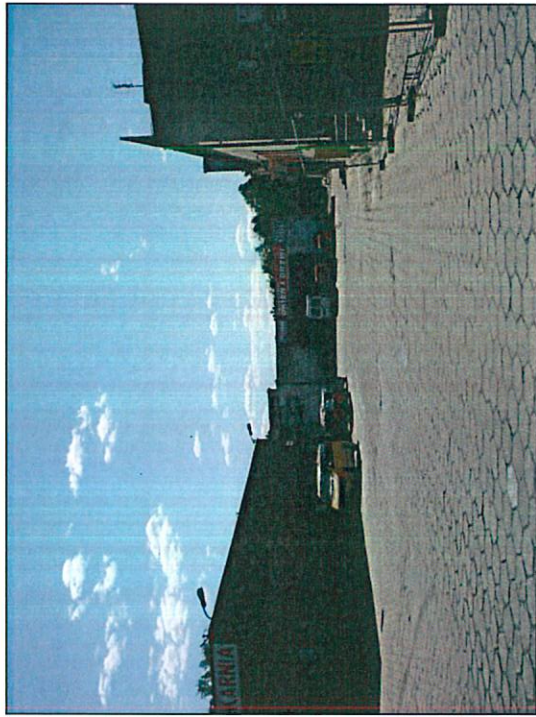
Teren nr 3, widok w kierunku wschodnim
